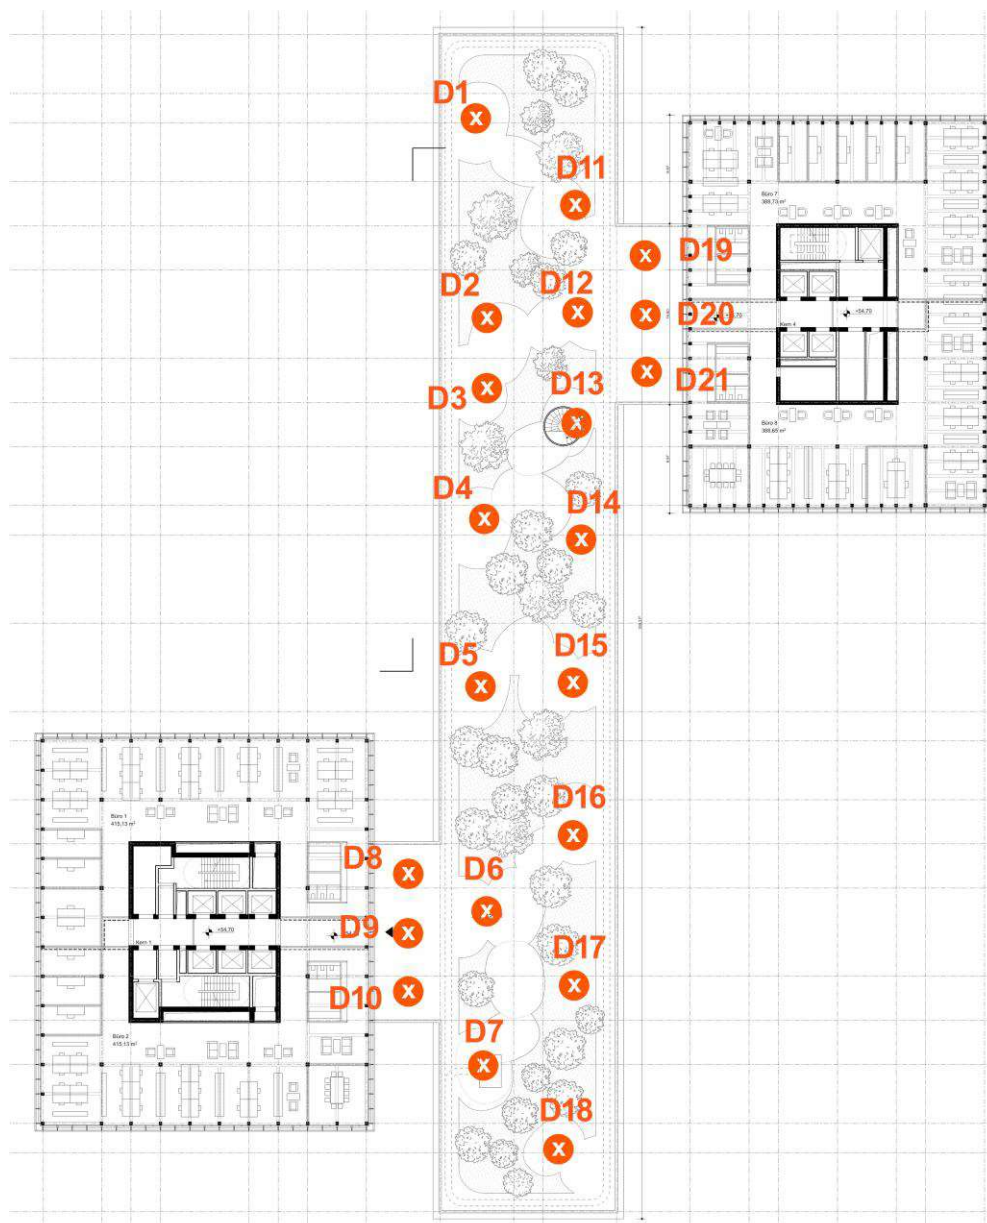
Grundriss 14:OG mit Messpositionen Nr. 1 – Nr.21 auf dem Dach des Riegels gültig für Variante 1, 2 und für Variante 3a und 3b nach Abb. 3.15 bis Abb. 3.19
